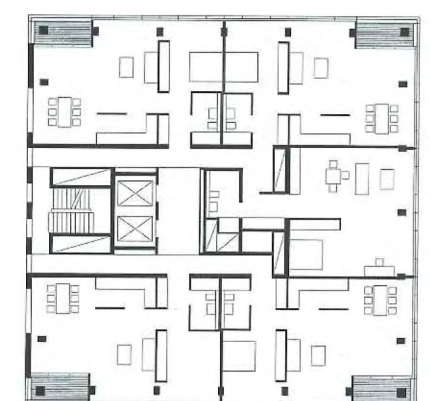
Grundriss Umbau 11. bis 14. OG, Fünfspänner (Quelle: Stefan Forster Architekten)
